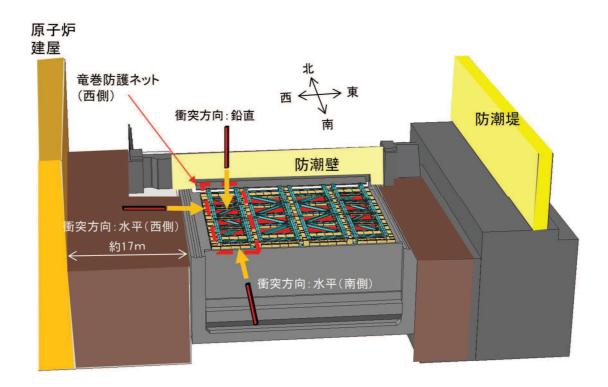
竜巻防護ネットの配置図(平面図・俯瞰図)
